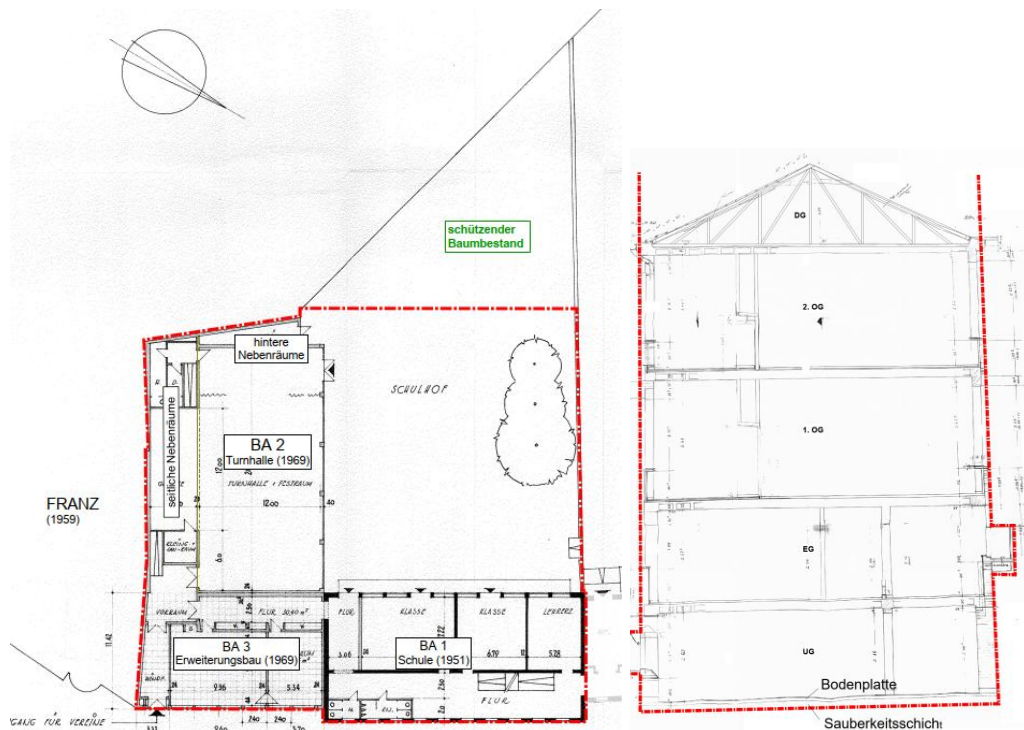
Rückbaugrenze Grundriss und Schnitt
